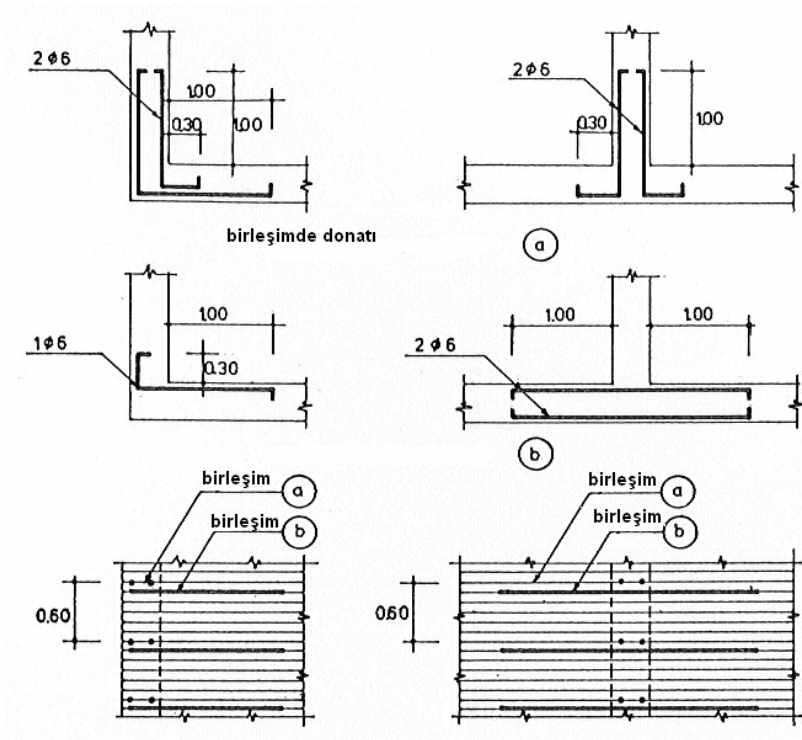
Betonarme düşey hatılların tipik detayı [5].
